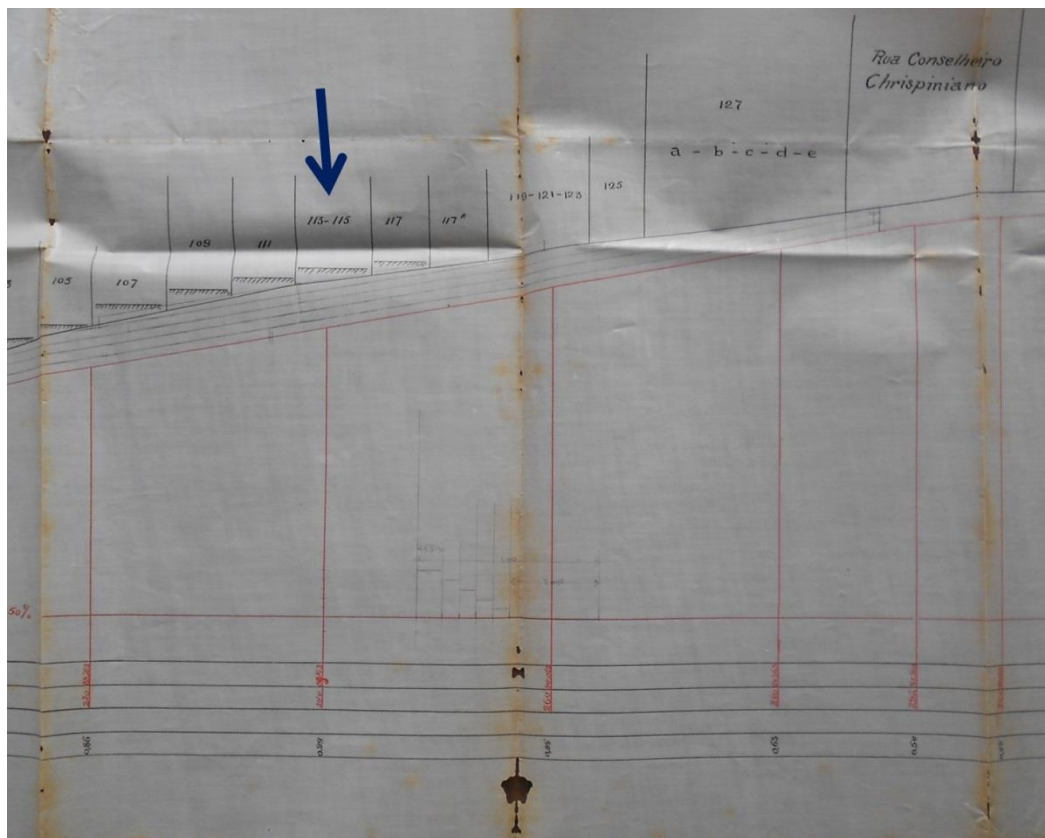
Pormenor do desenho do corte do terreno da Rua São João, do processo de pavimentação da via. Fonte: SIURB.
